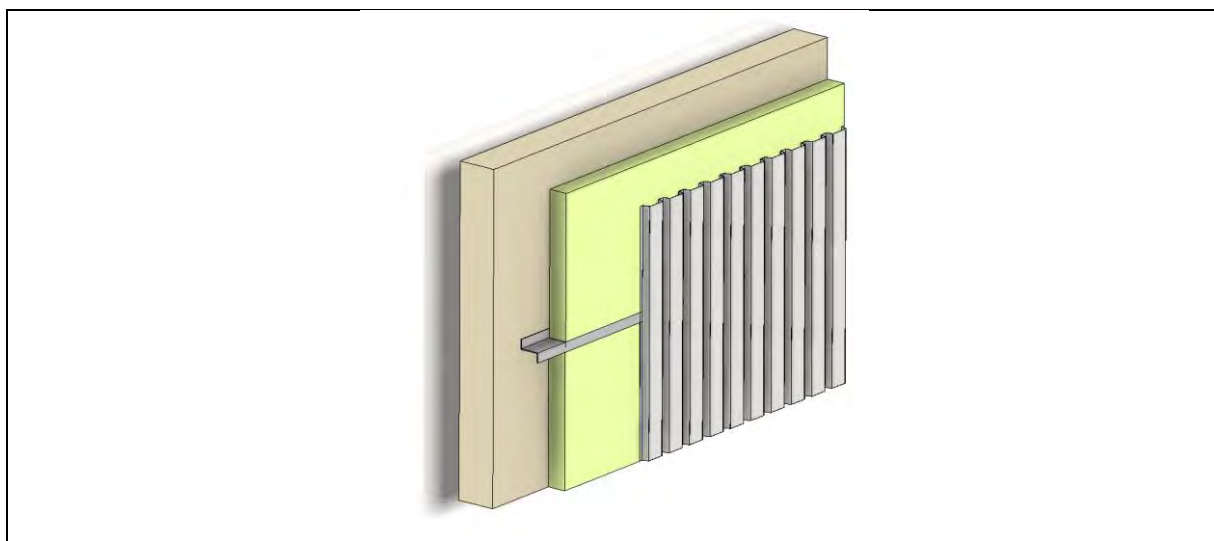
Sanierung einer massiven Fassade mit Trapezprofilen
